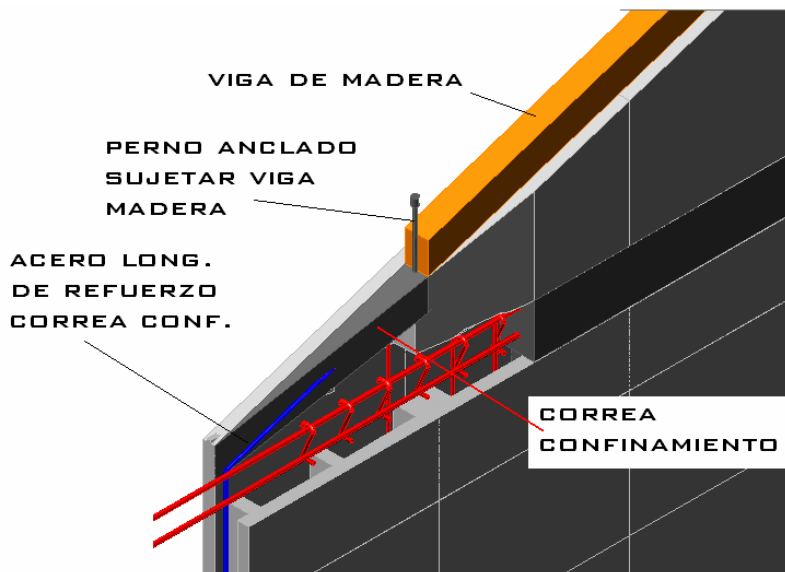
DETALLE REFUERZO UNIÓN VIGA CULATAS DE TECHO.
